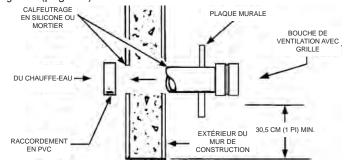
Installation d'une bouche d'extrémité à travers un mur
